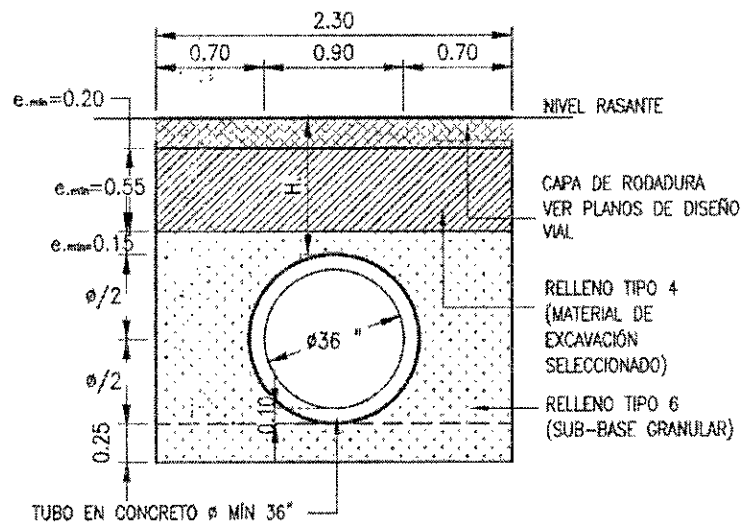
Esquema general de alcantarilla transversal de 36" (Vista de Sección Transversal)
